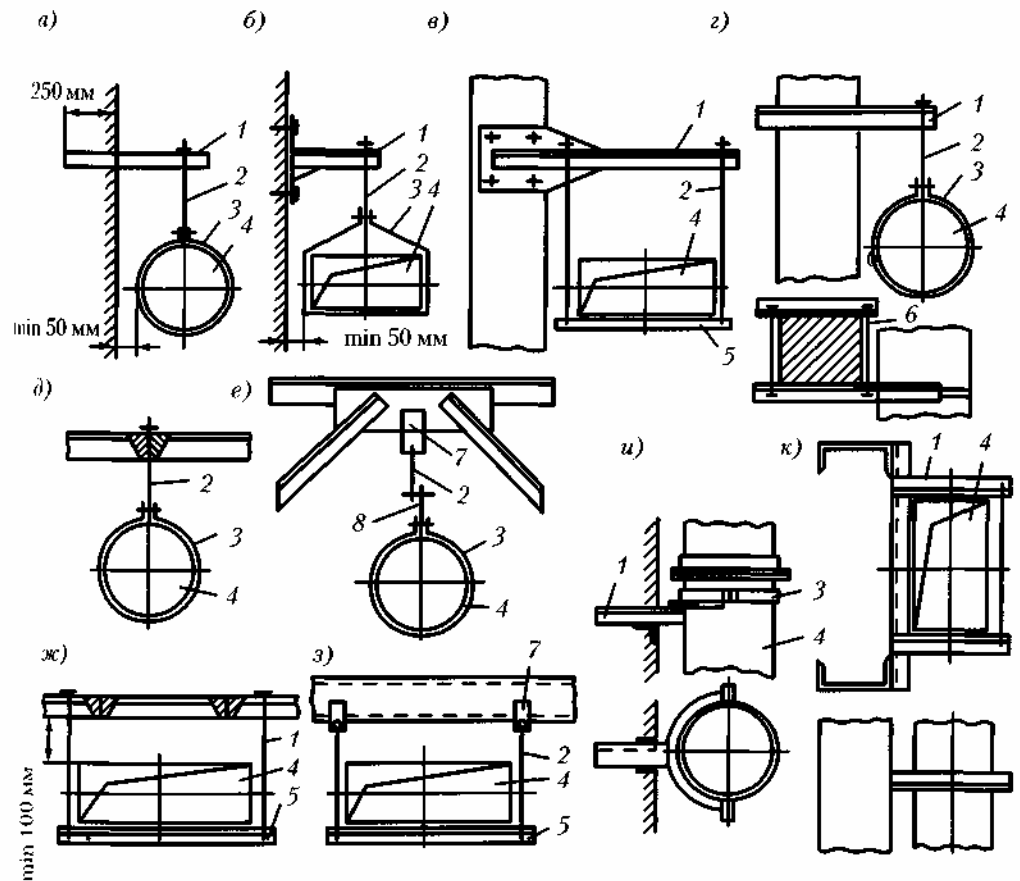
Виды креплений воздуховодов: *а-з* — горизонтальных воздуховодов; *и-к* — вертикальных воздуховодов; *а, и* — к стенам; *б, в, г, к* — к колоннам; *д, е* — к перекрытиям; *ж, з* — к фермам и прогонам:
